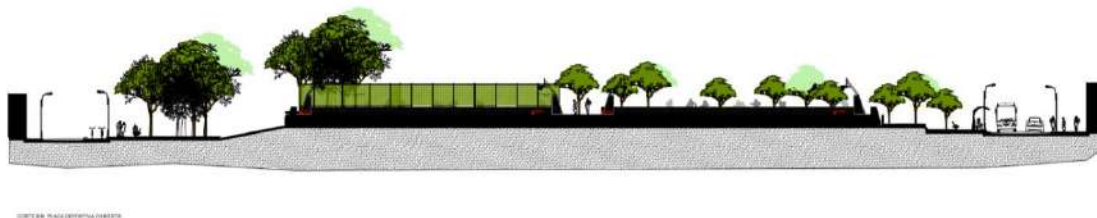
Sección longitudinal parque Cristo Rey. Fuente: Elaboración propia 2021.
